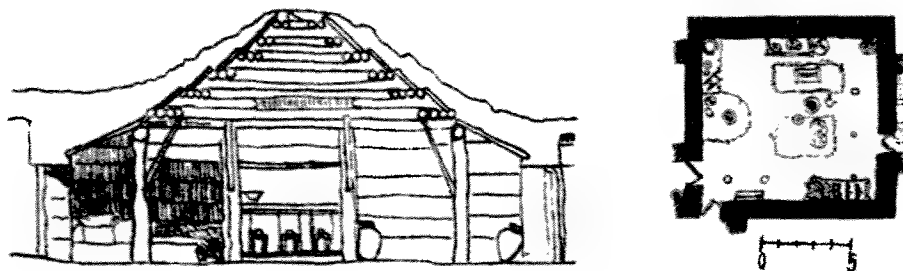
Глхатун — армянское народное жилище. Разрез. План
